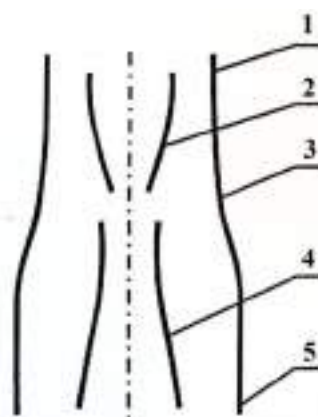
Схема узла рельсовых путей для смены колеи: 1 – узкая колея; 2,4 – направляющие для приводной головки; 3 – промежуточный участок; 5 – широкая колея
